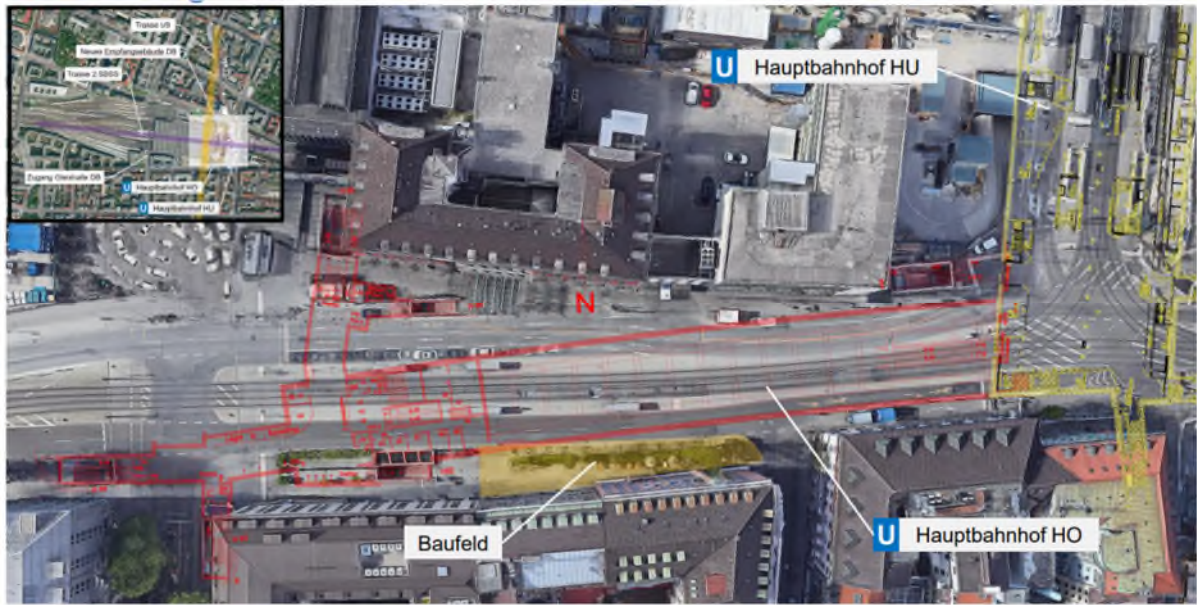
Lageplan U-Bahn-Station HO, Bayerstraße; Quelle: Google Earth
